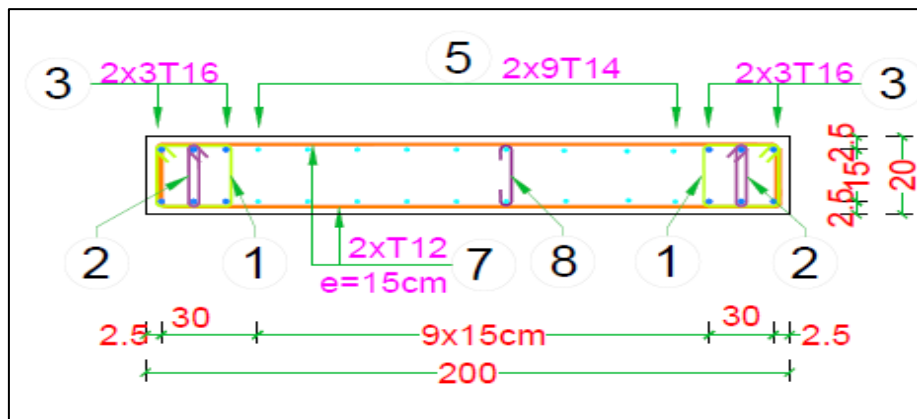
Schéma de Ferrailage des voiles niveau RDC (360X20)cm².
